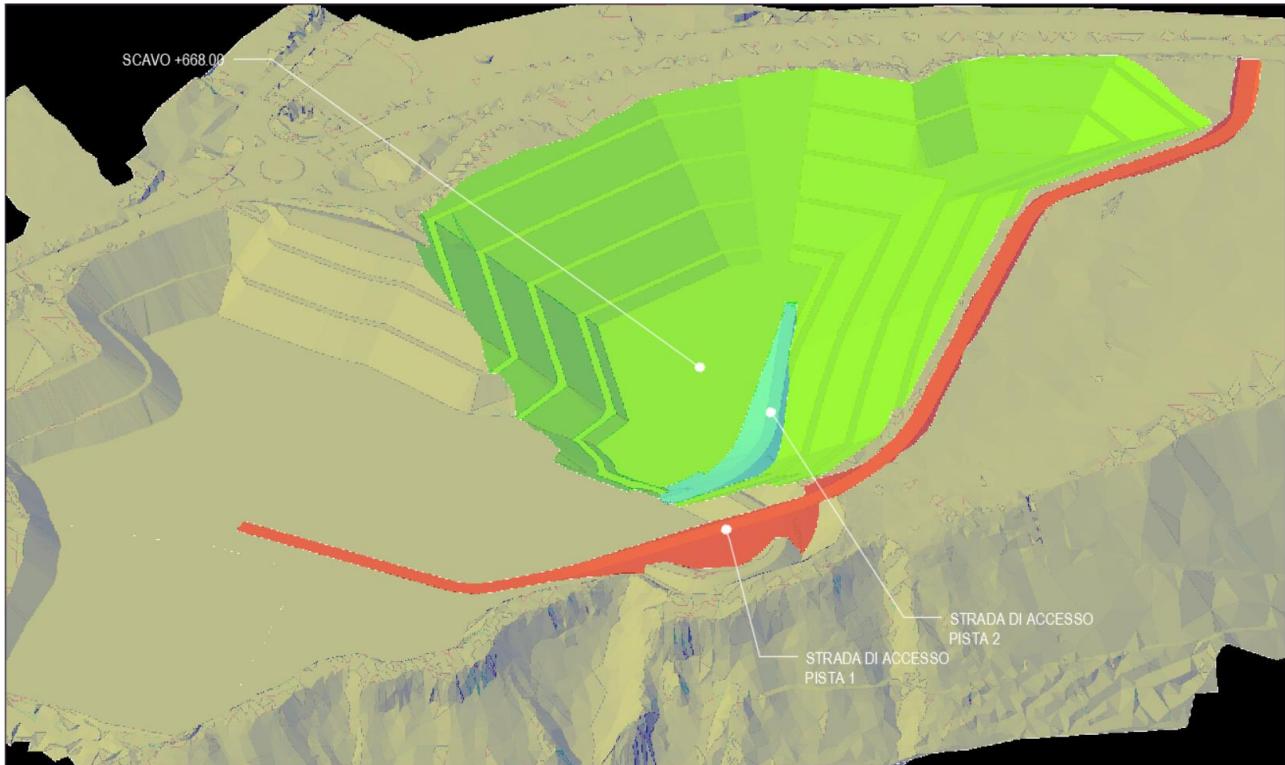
Stralcio planimetrico e Vista 3D della Fase 2 della cava di Forch II
